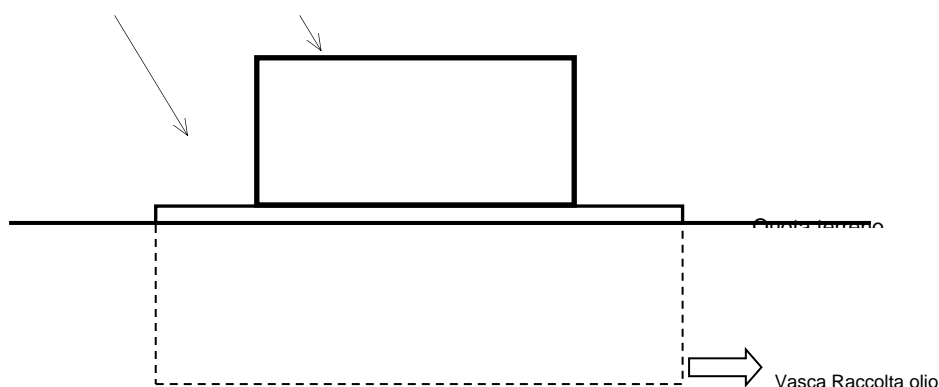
Rappresentazione schematica del sistema Vasca-Fondazione
